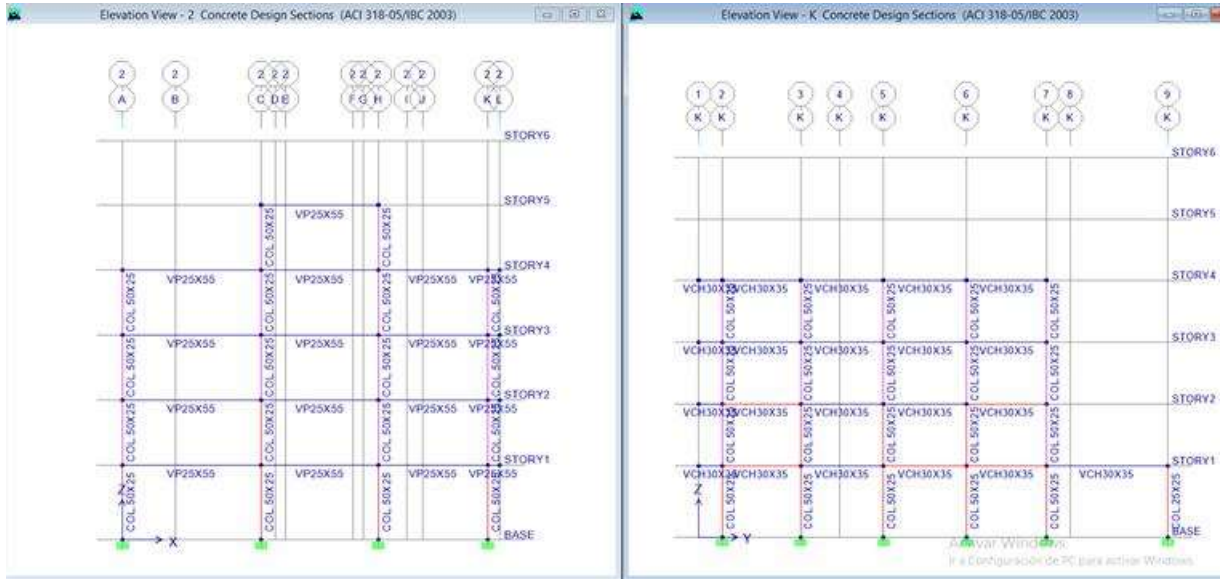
vistas laterales del edificio diseñado de concreto armado con su predimensionamiento
